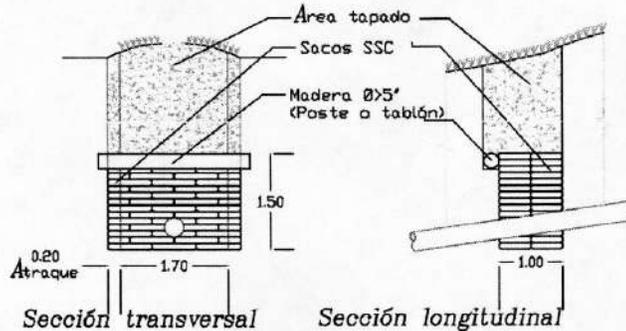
Detalles barreras de sacos suelo-cemento para bajado de tuberías y excavaciones
